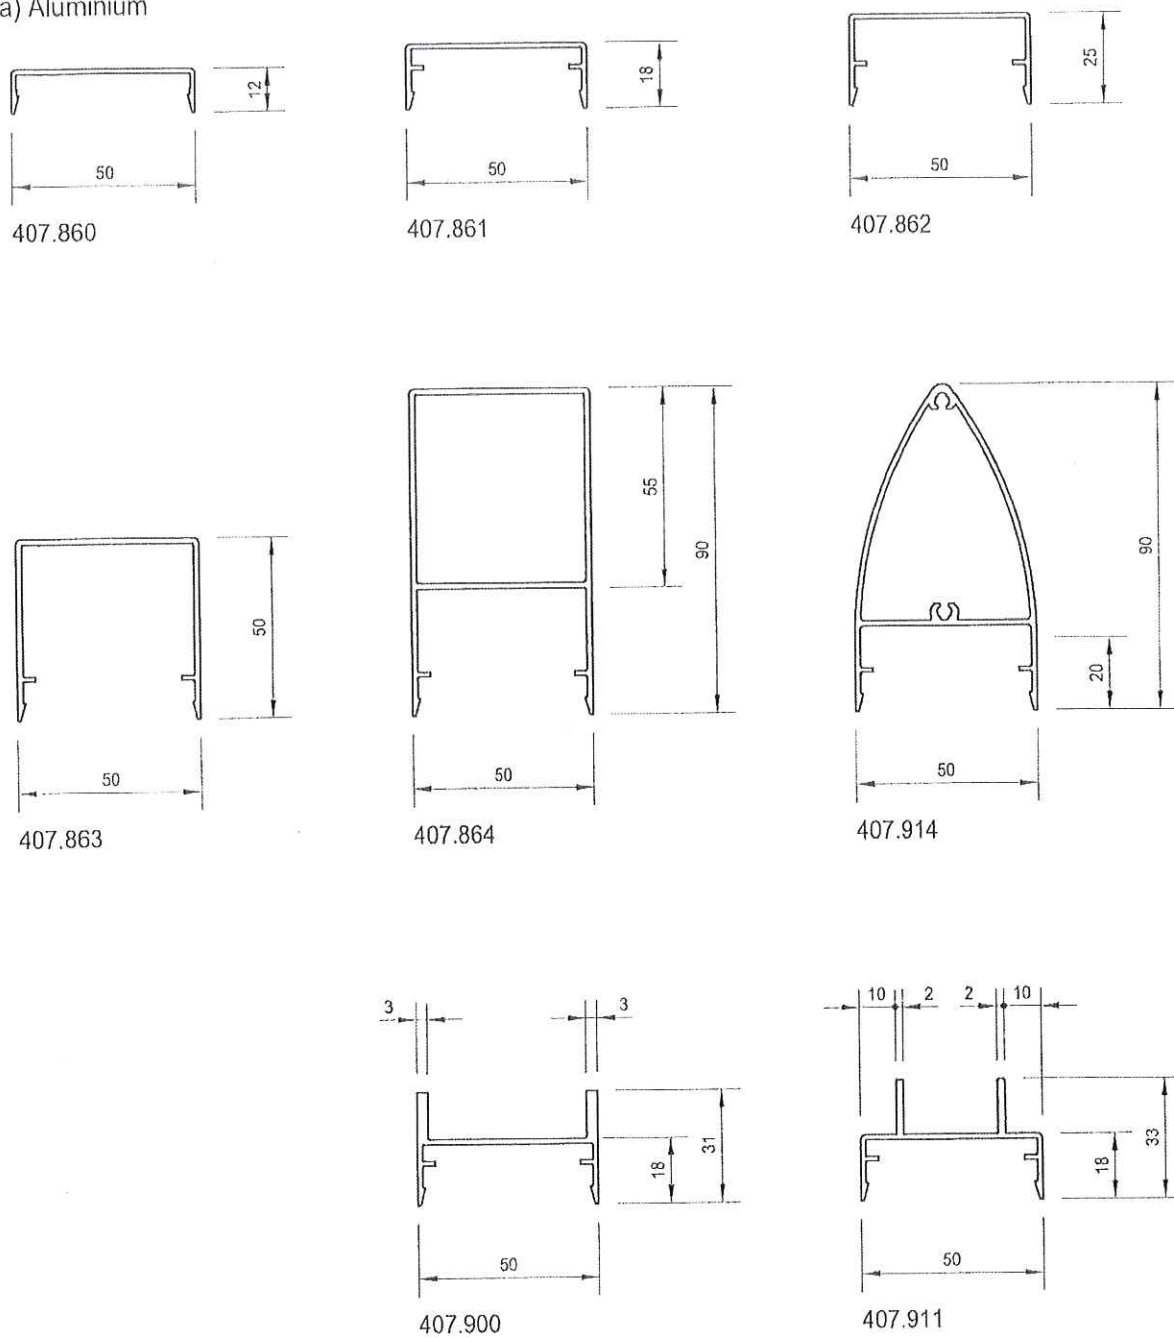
Profile konstrukcyjne systemu Jansen-VISS®
